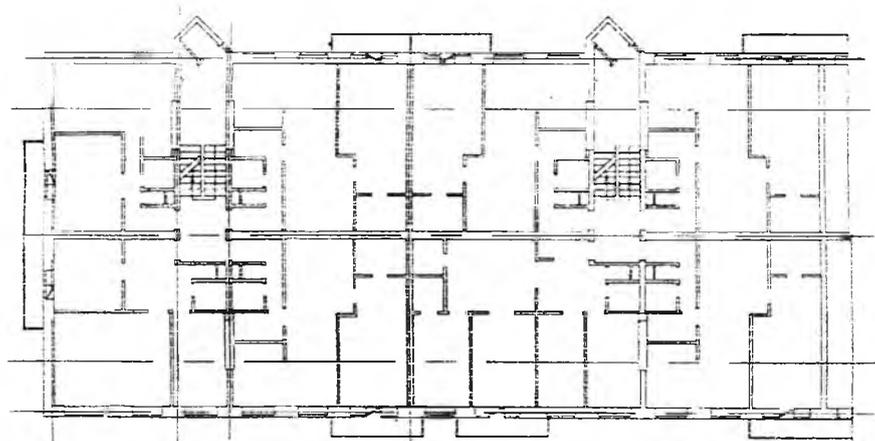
Планировки этажей дома серии 1-510 после реконструкции с надстройкой на 3...4 этажа
